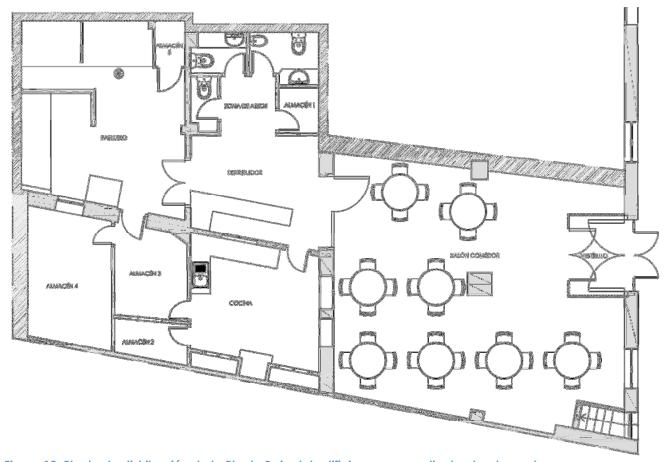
Planta de distribución de la Planta Baja del edificio, correspondiente al restaurante
